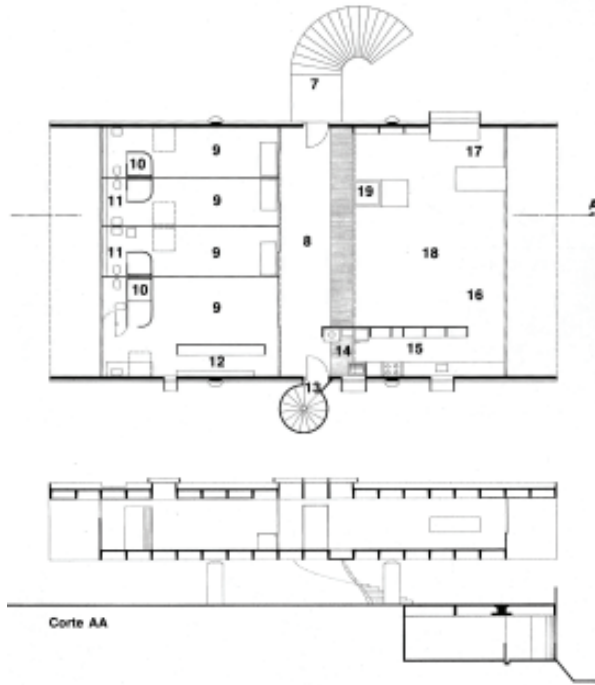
Residência Mário Masetti – Planta do pavimento superior e corte
